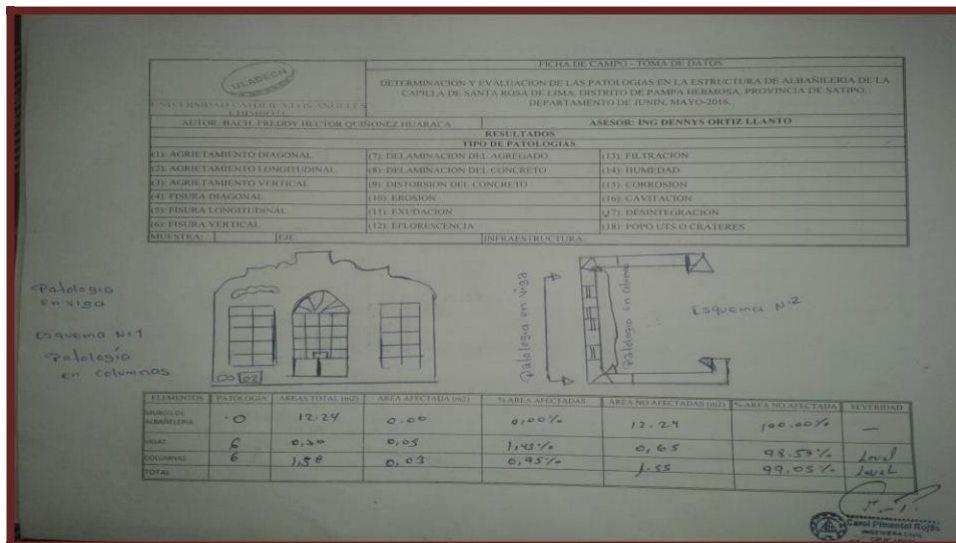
En el eje A - B entre 4 - 4 Se puede apreciar que fue afectado por fisuras verticales
